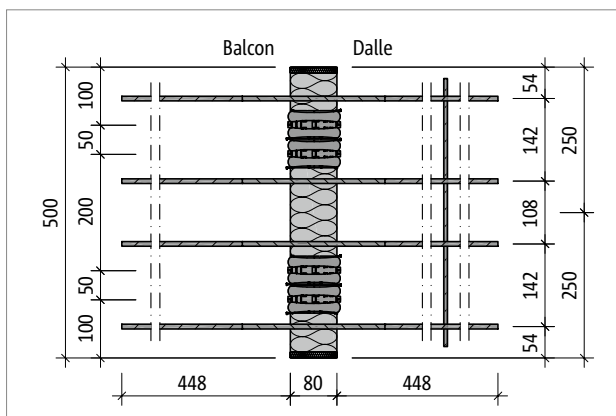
Schöck Isokorb® T type Q-E-V4-L500 : plan de base du produit
